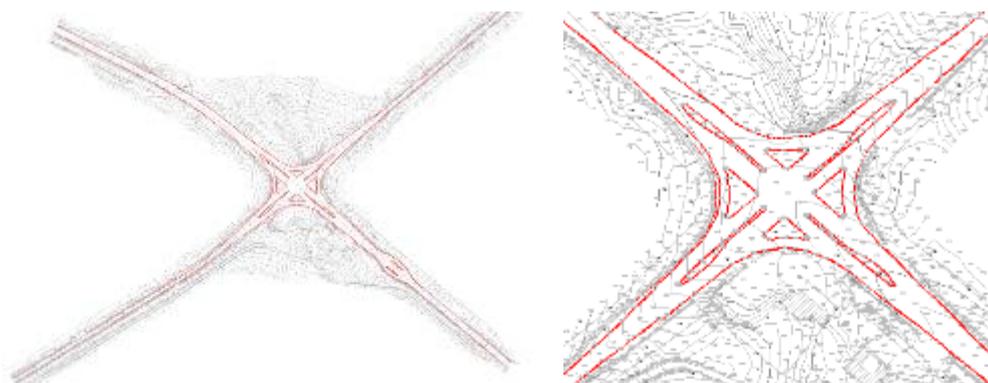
Levantamiento y una vista más cercana a la geometría de la intersección
